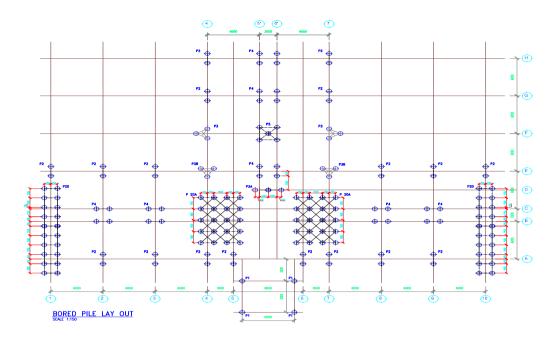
Detail Pondasi Sumber: Data penelitian, 2021
